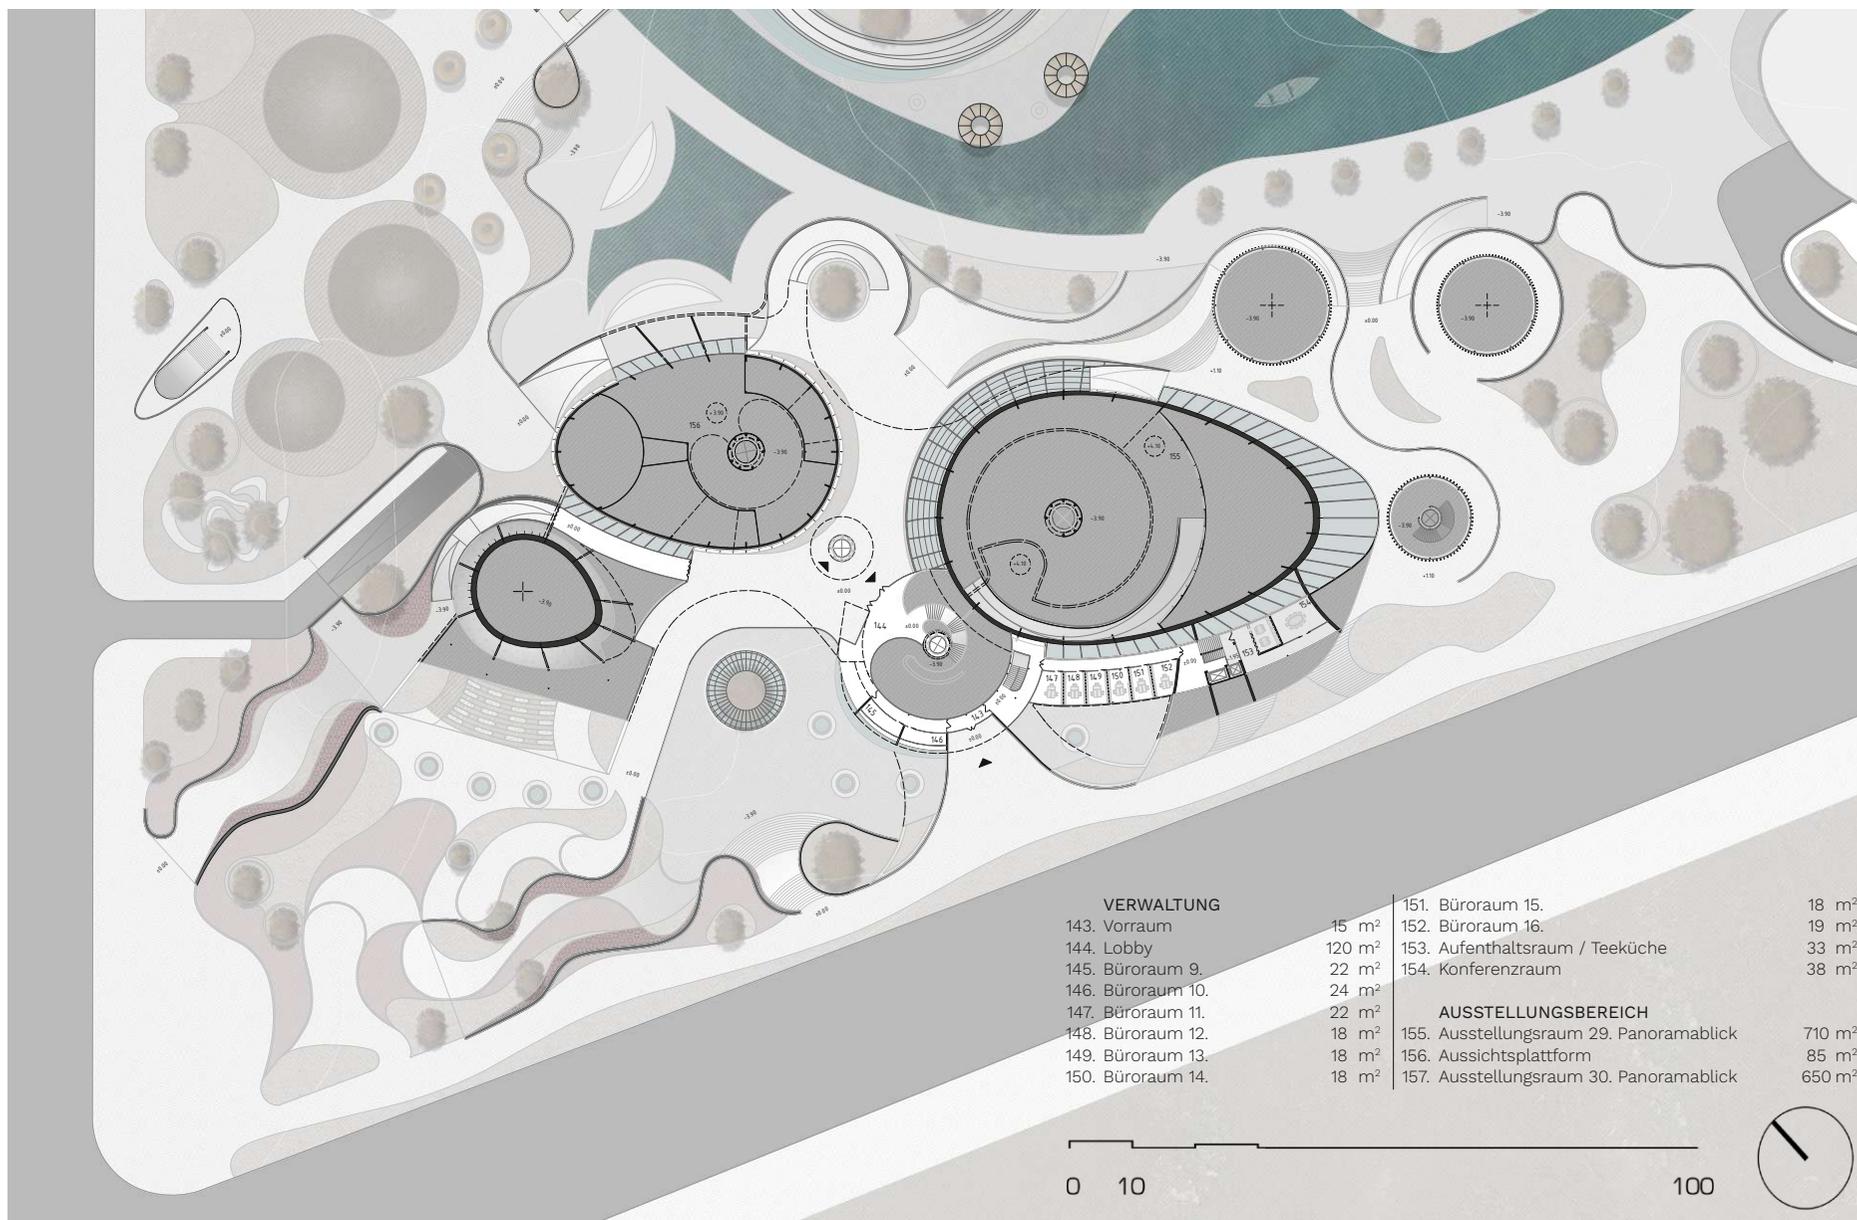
Grundriss. OG1, Niveau 0,00
